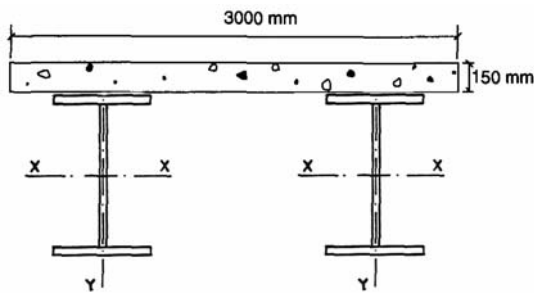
Seção transversal típica de uma passarela em estrutura mista (aço-concreto)
